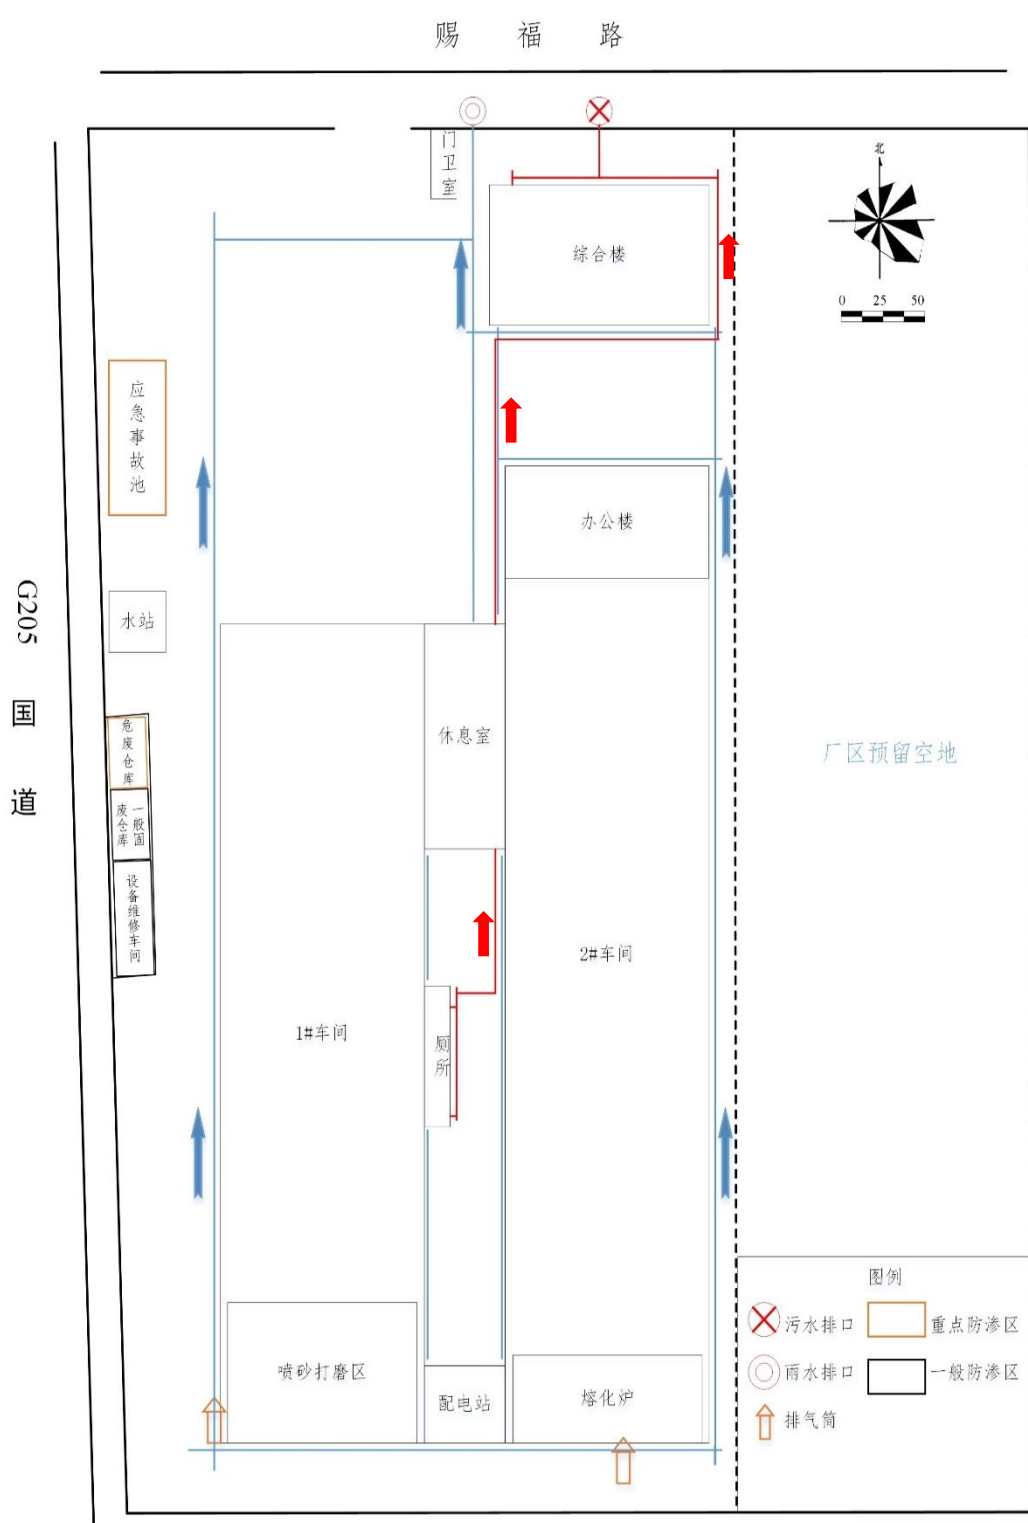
项目（一阶段）厂区总平面布置图（含雨、污管网）
